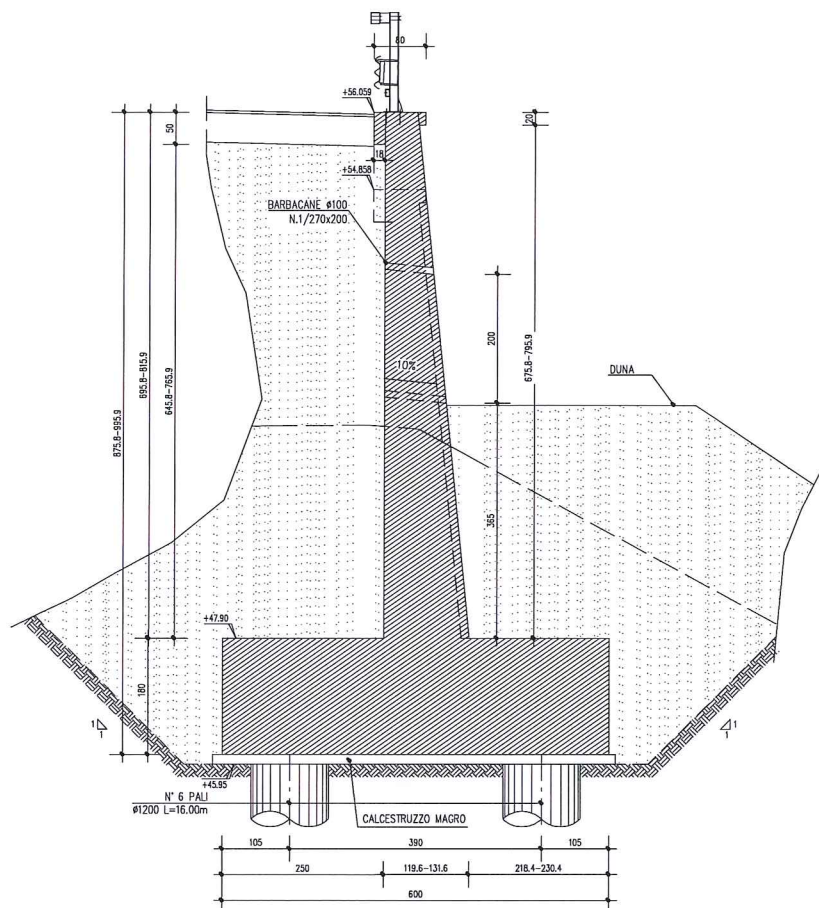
Sezione Tipo - Muro 3 Conci da 16 a 25
